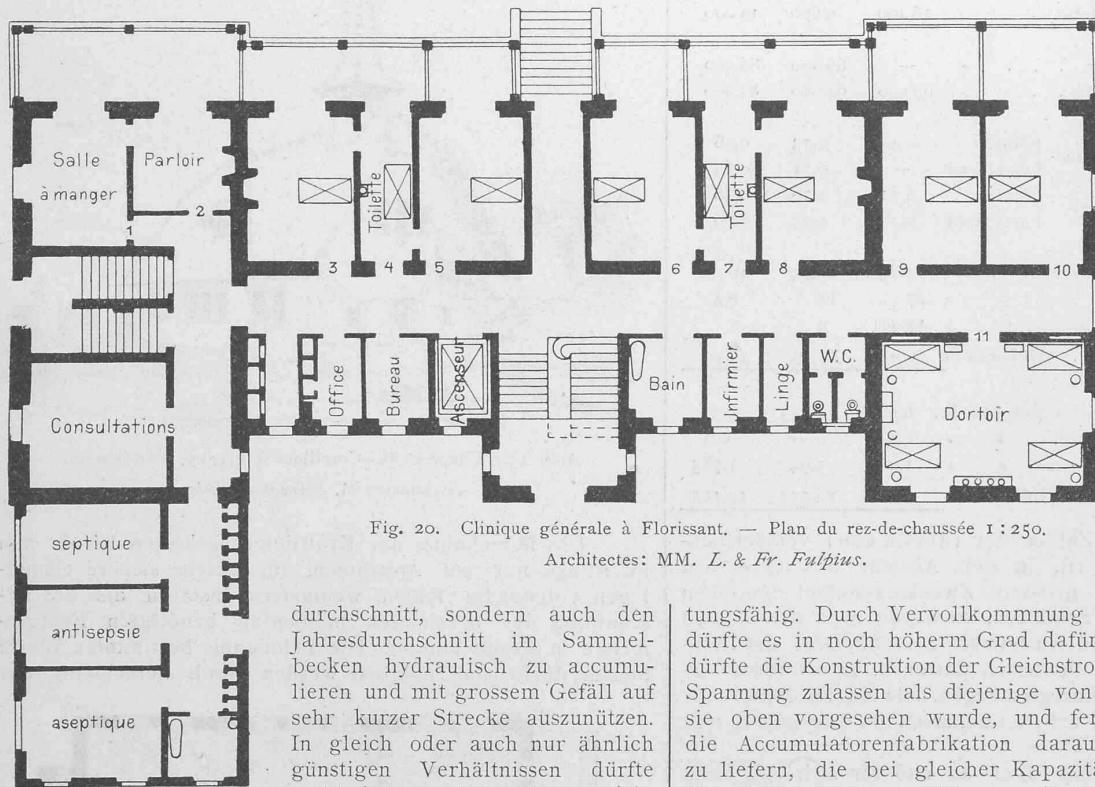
Clinique générale à Florissant. — Plan du rez-de-chaussée 1:250.
